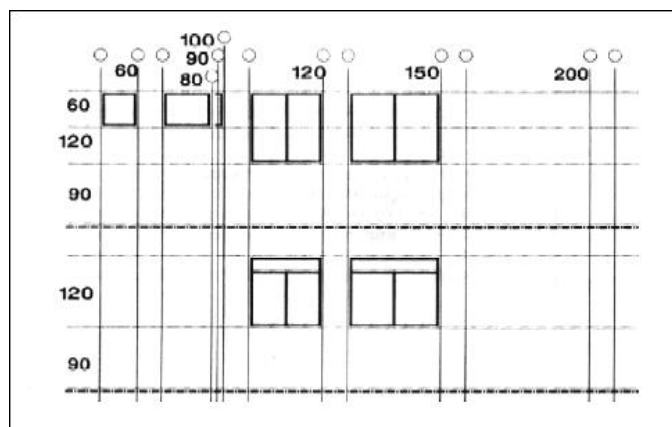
DETALHE DA DISPOSIÇÃO DE TIJOLO
